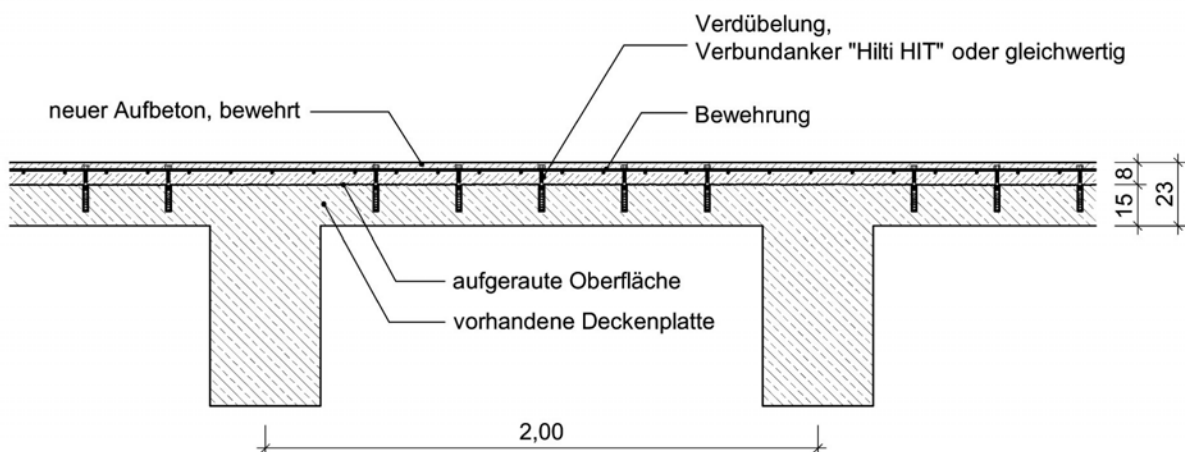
Verstärkung einer Deckenplatte durch Aufbeton [33]
